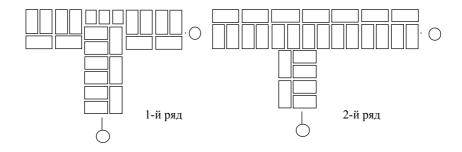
Кладка примыканий стен толщиной в 1 кирпич
